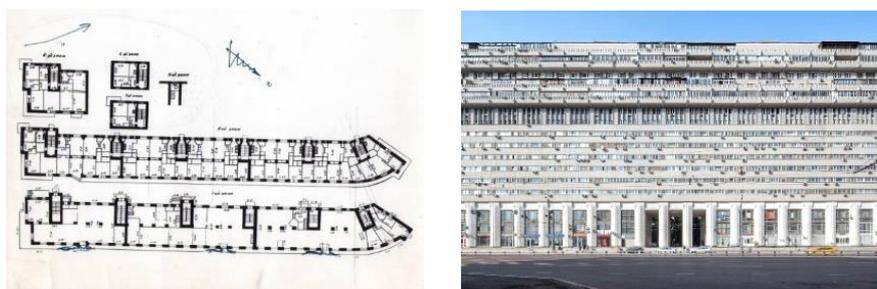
Планировка Жилого дома на ул. Тульской (Дом атомщиков)
